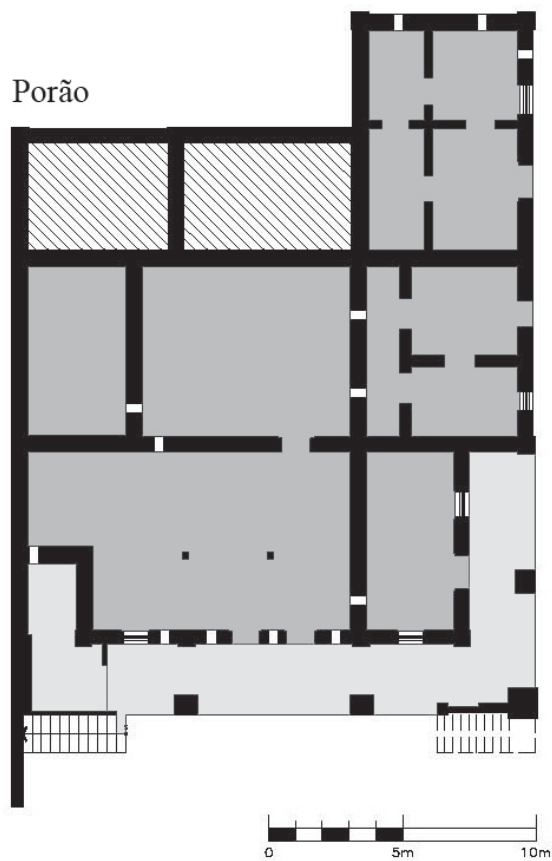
(acima, topo) - Planta do casarão da fazenda São João, em Agudos. Levantamento: V. Benincasa e R. G. Giandressi. Desenho: M. Rosada.
